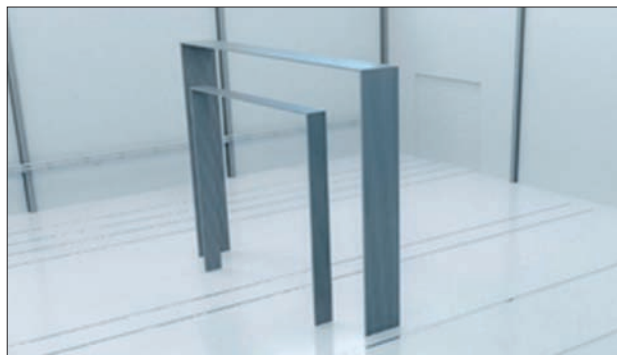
Сборка секций и стыковка их в общий несущий каркас
